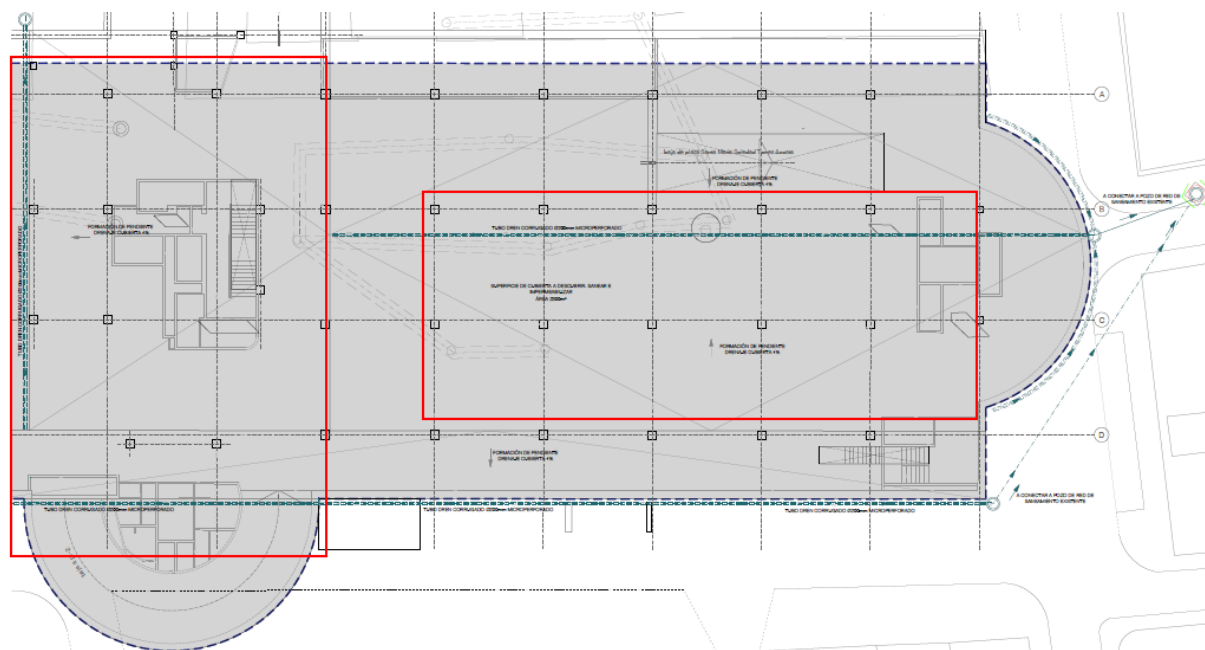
Zona de levantamiento del pavimento para reparación cubierta
